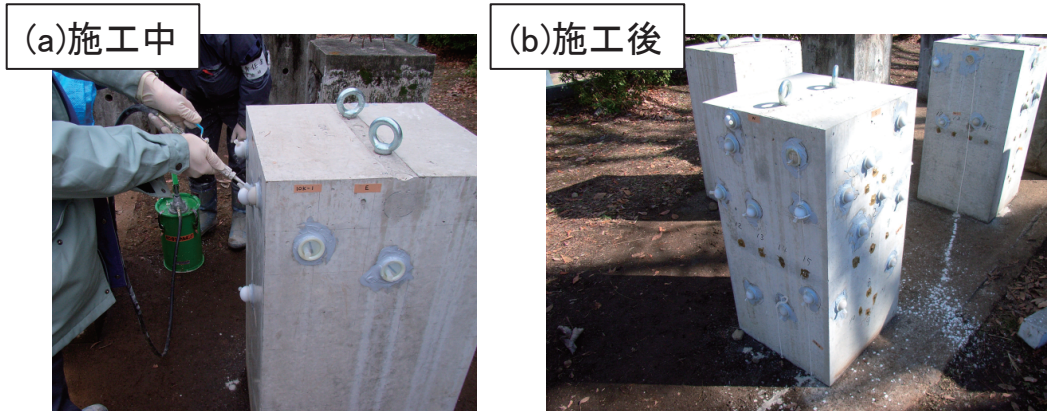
ASRが生じたコンクリート供試体へのひび割れ注入施工状況
